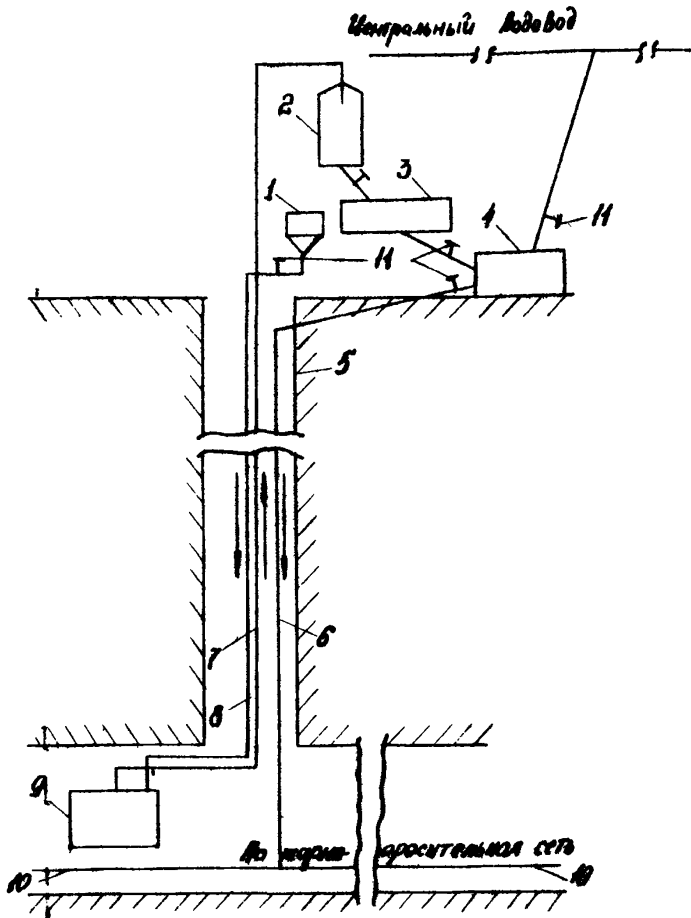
Схема использования кислых шахтных вод для пожарно-оросительного водоснабжения:
